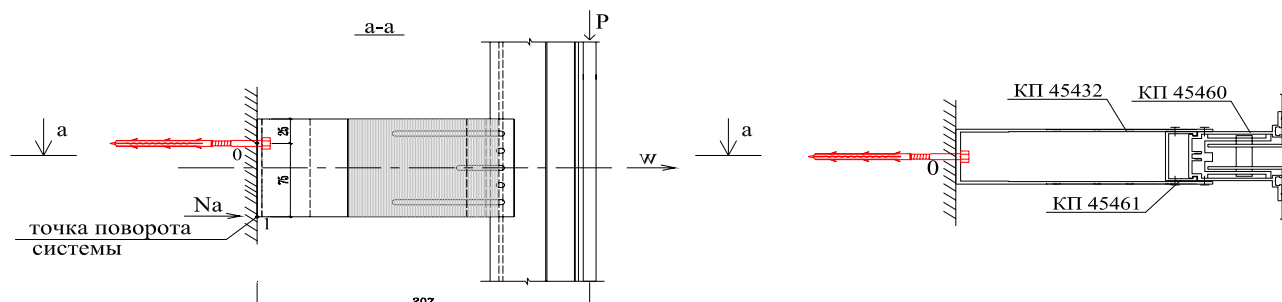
Схема для расчета усилия на анкер на рядовом и угловом участках стены при высоте до 100 метров.
